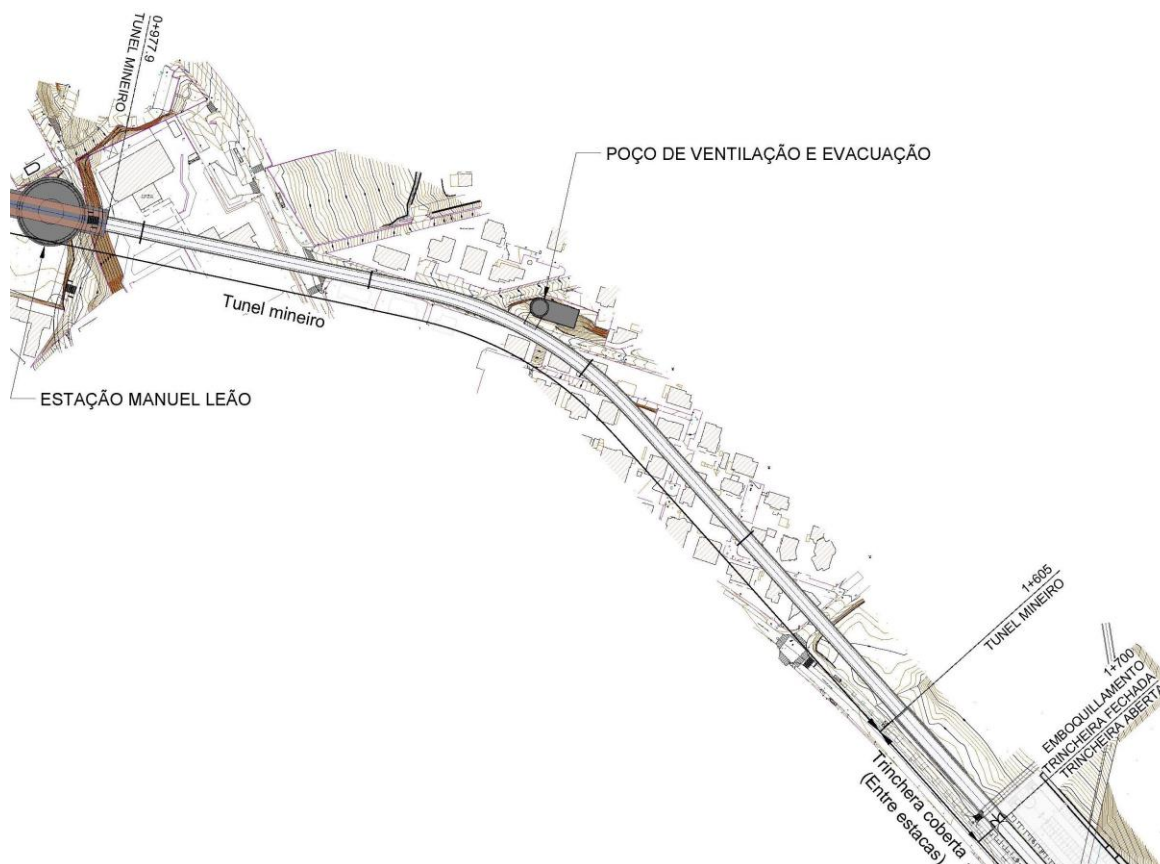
Traçado em túnel e trincheira coberta entre a Estação Manuel Leão e o km 1+700
